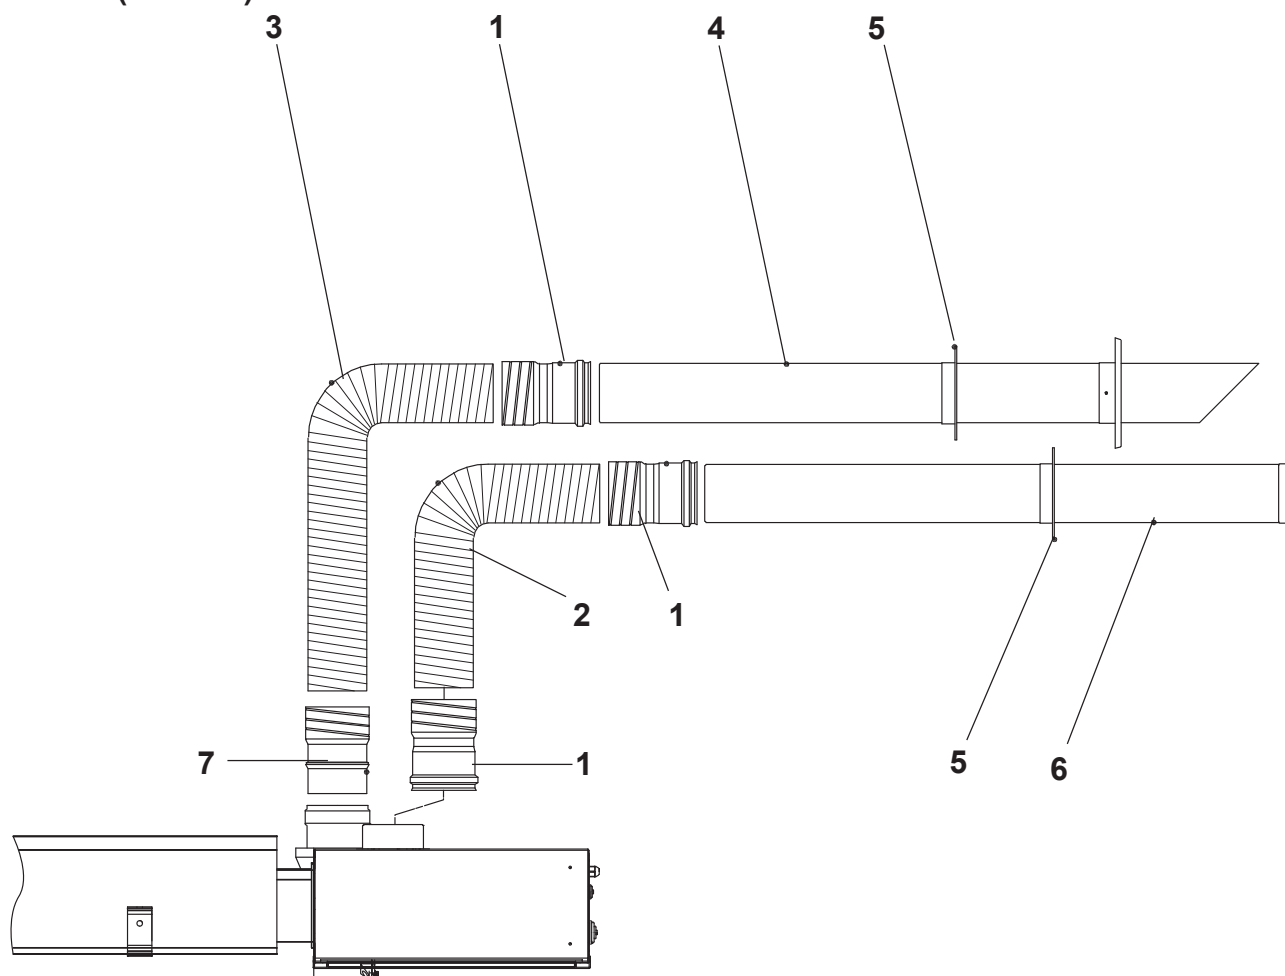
Дымоудаление и ввод воздуха через стену в отдельных трубопроводах (тип С12 Таб. 6.1 деталь В)
